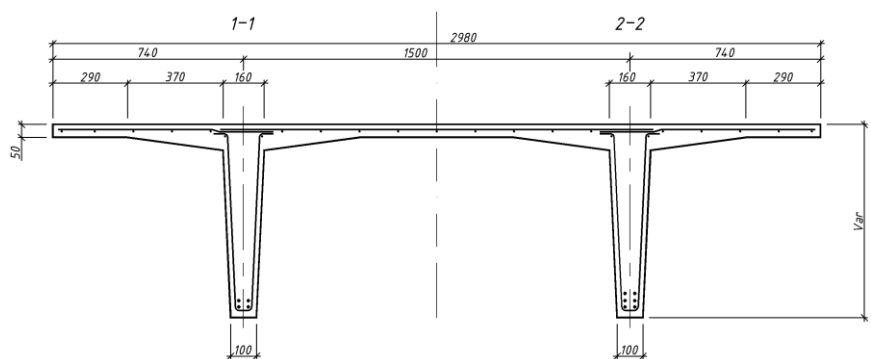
Поперечное сечение малоуклонных плит 2Т
